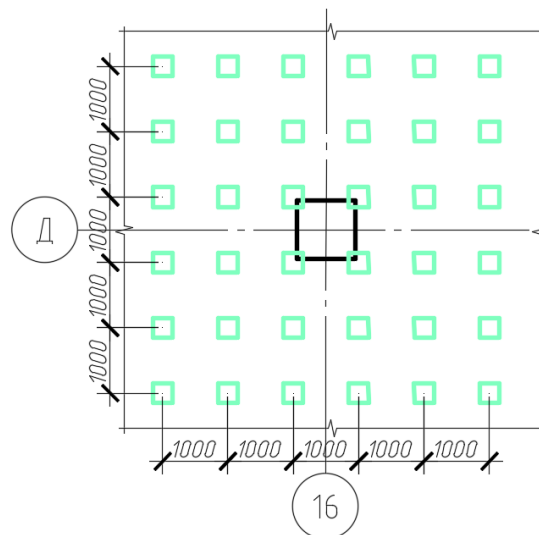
Схема расположения свай под фрагмент плитного фундамента
